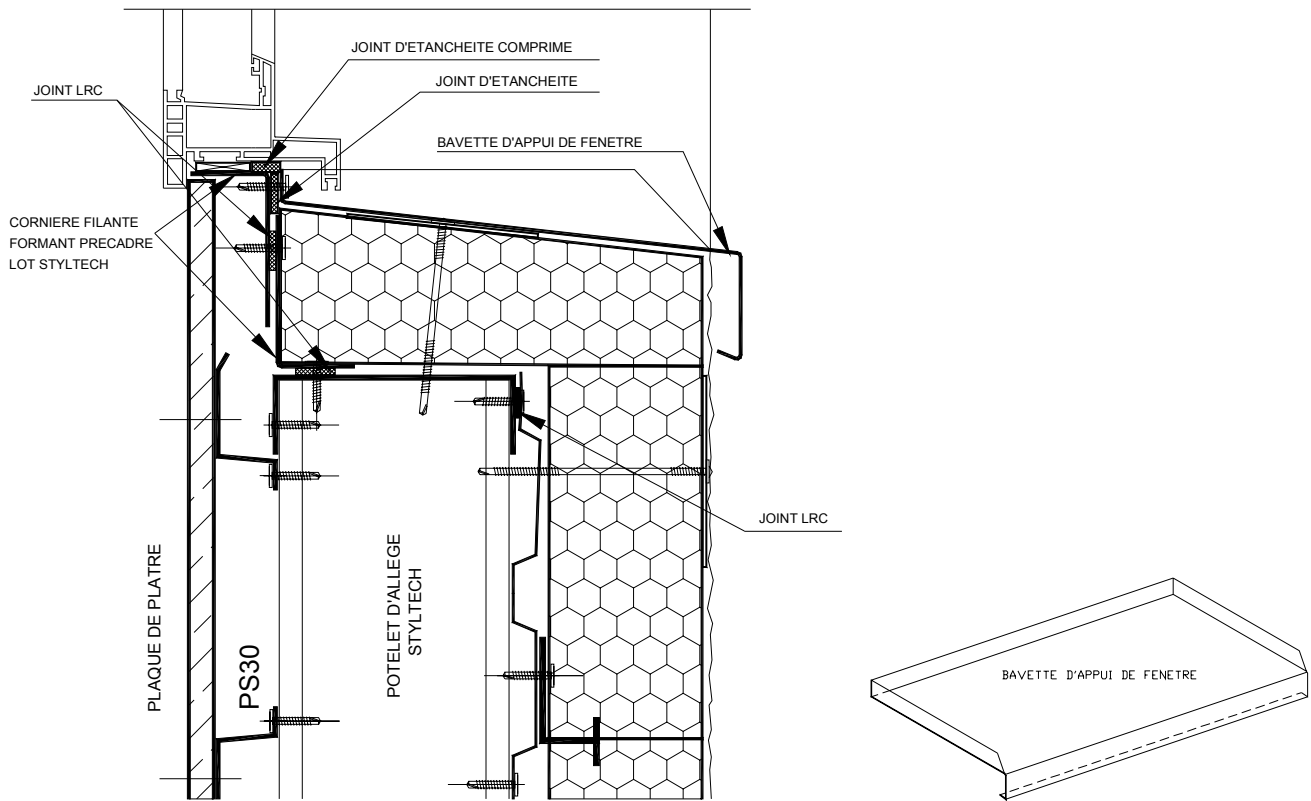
Coupe verticale sur fenêtre – Traverse basse – Menuiserie au nu intérieur
